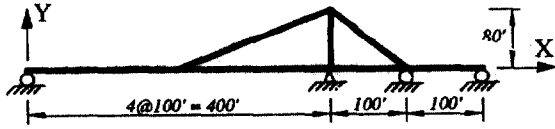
Plane Cable-Stayed Bridge Model proposed by M. C. Tang.
